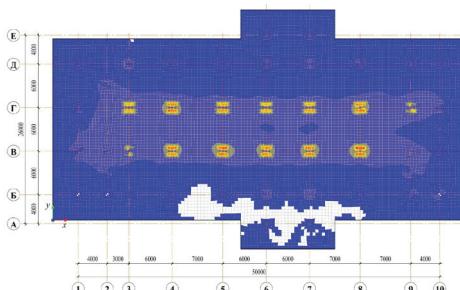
Цементно-грунтовое основание толщиной 6 м ($E = 42$ МПа). Карта нижнего армирования фундаментной плиты по оси « Y ». Требуемая площадь рабочей арматуры от 4,43 см²/м (5Ø12) до 8,85 см²/м (5Ø16)
